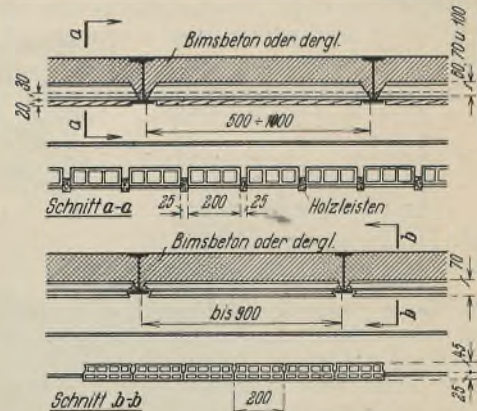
Hourdisdecken der Pariser Stahlskelettbauten.
